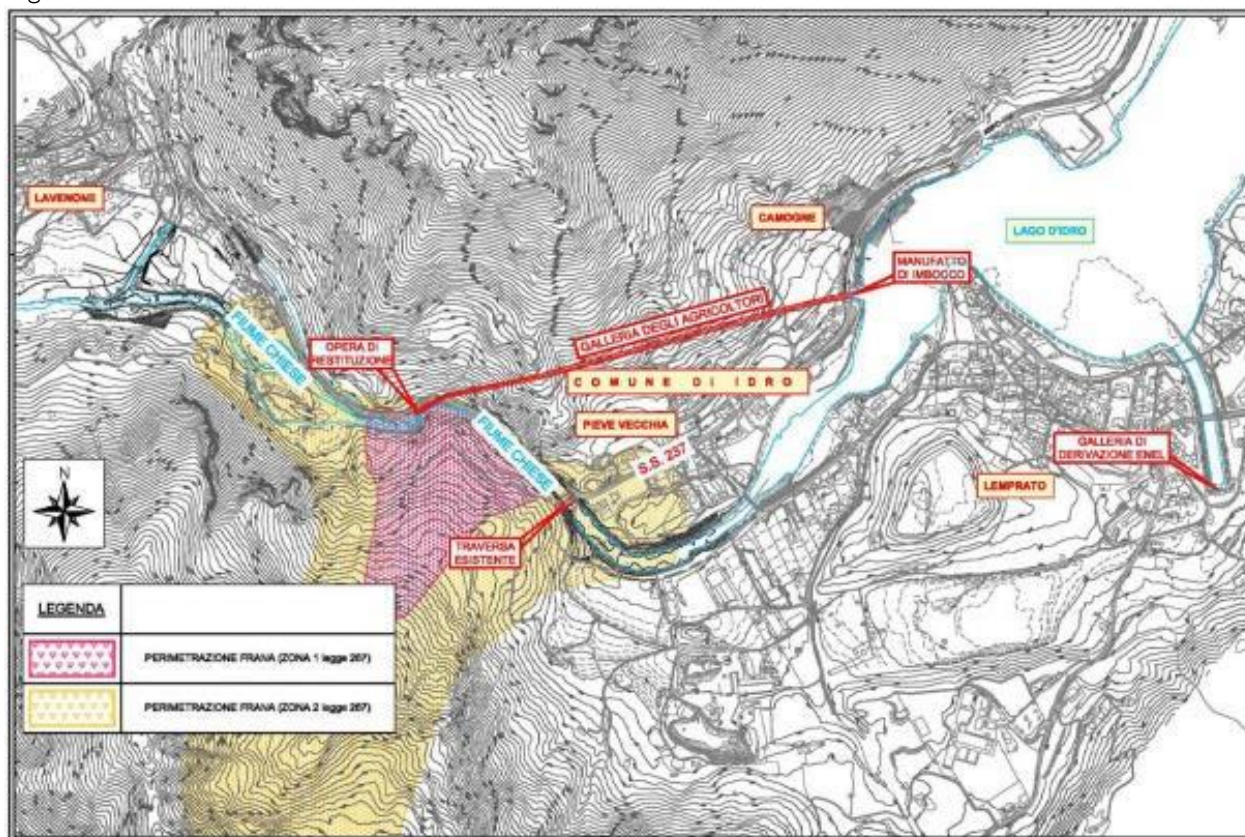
Planimetria dello stato di fatto con perimetrazione del pendio in frana (legge 267/98: aree ad elevato rischio idrogeologico)
